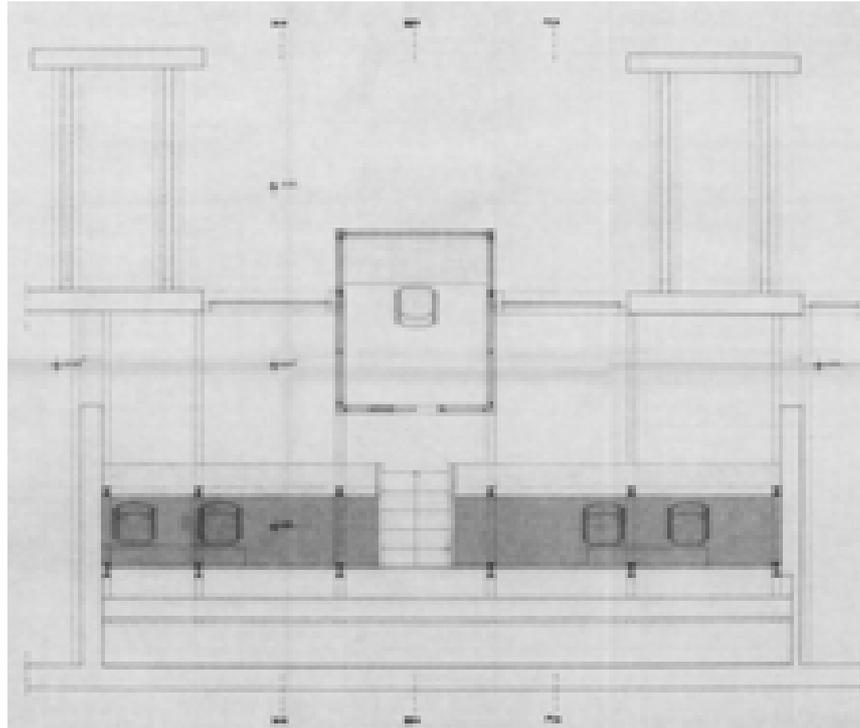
Pianta regia piano soppalco, opere di completamento – 22/04/1997 (AABS-501)
